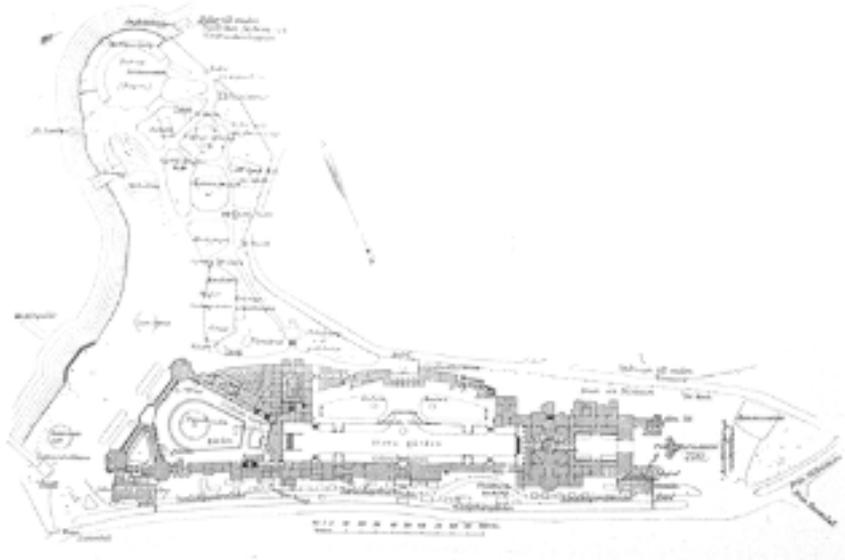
Ferdinand Boberg: Stockholmer Ausstellung 1909, Situationsplan.
